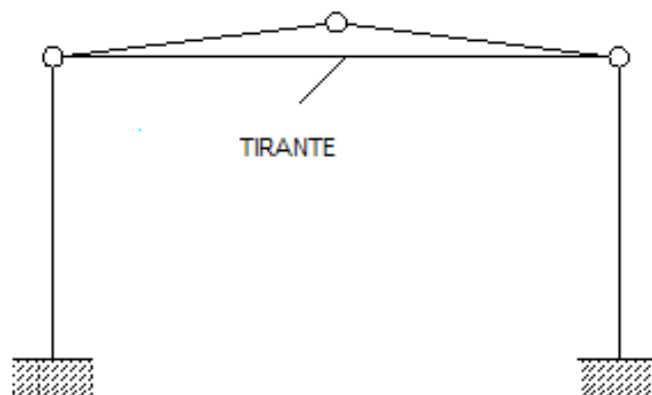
Sistema estrutural para galpão de duas águas com pilares engastado na fundação e dois elementos de cobertura articulados.
